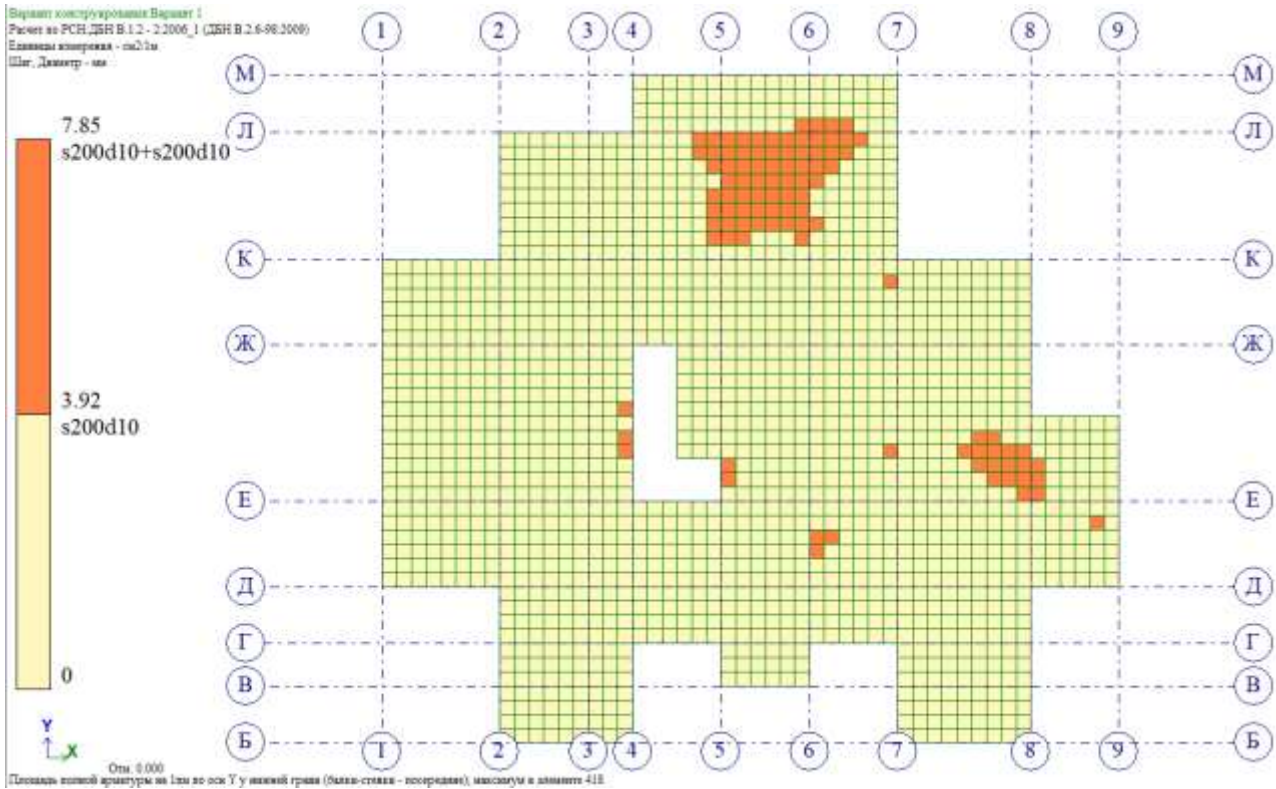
Арматура плити перекриття по нижній грані вздовж осі У
